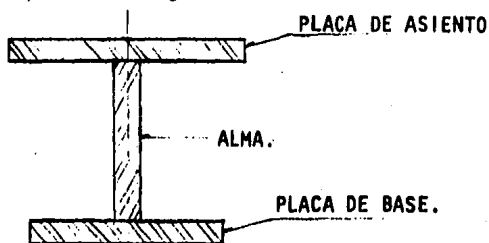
SECCION TRANSVERSAL DE UNA SILLETA.
